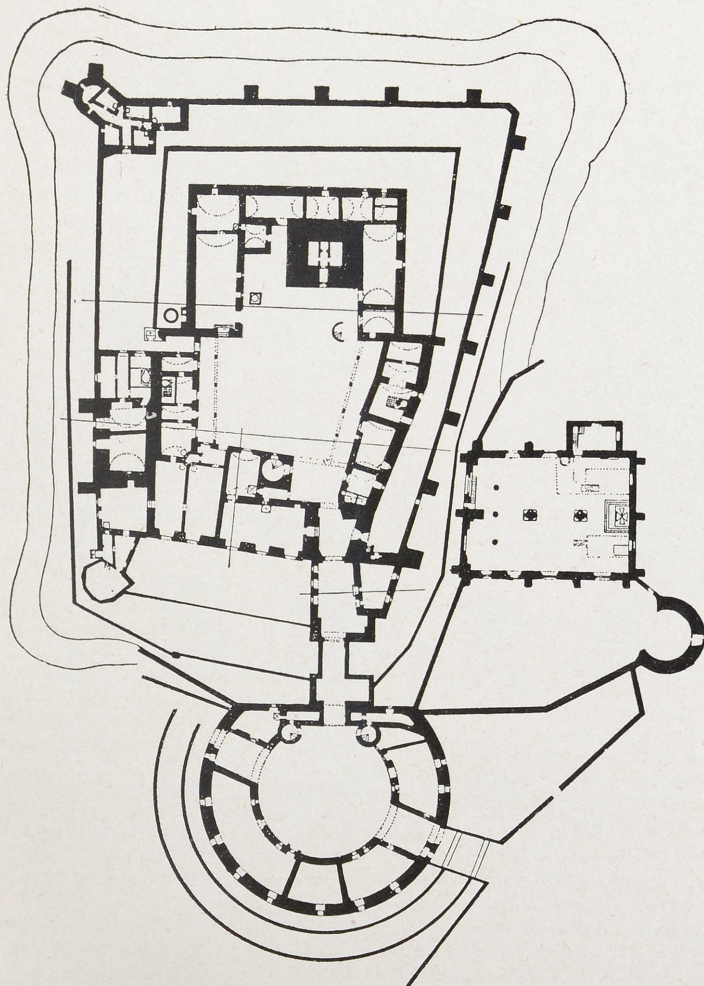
1 : 1100 Pöggstall. Schloß. Grundriß.
